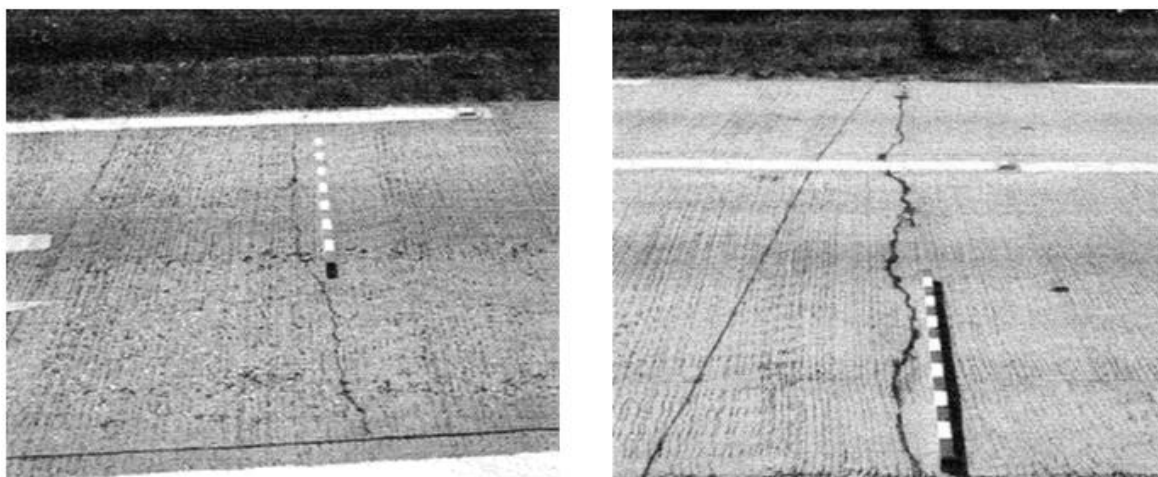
Fissure transversale d'une chaussée rigide
